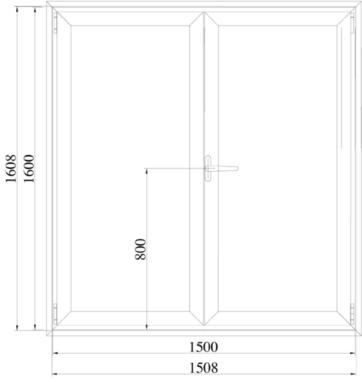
Prospetto - vista interna - del campione pervenuto e sottoposto a prova (dimensioni nominali dichiarate, espresse in mm)
